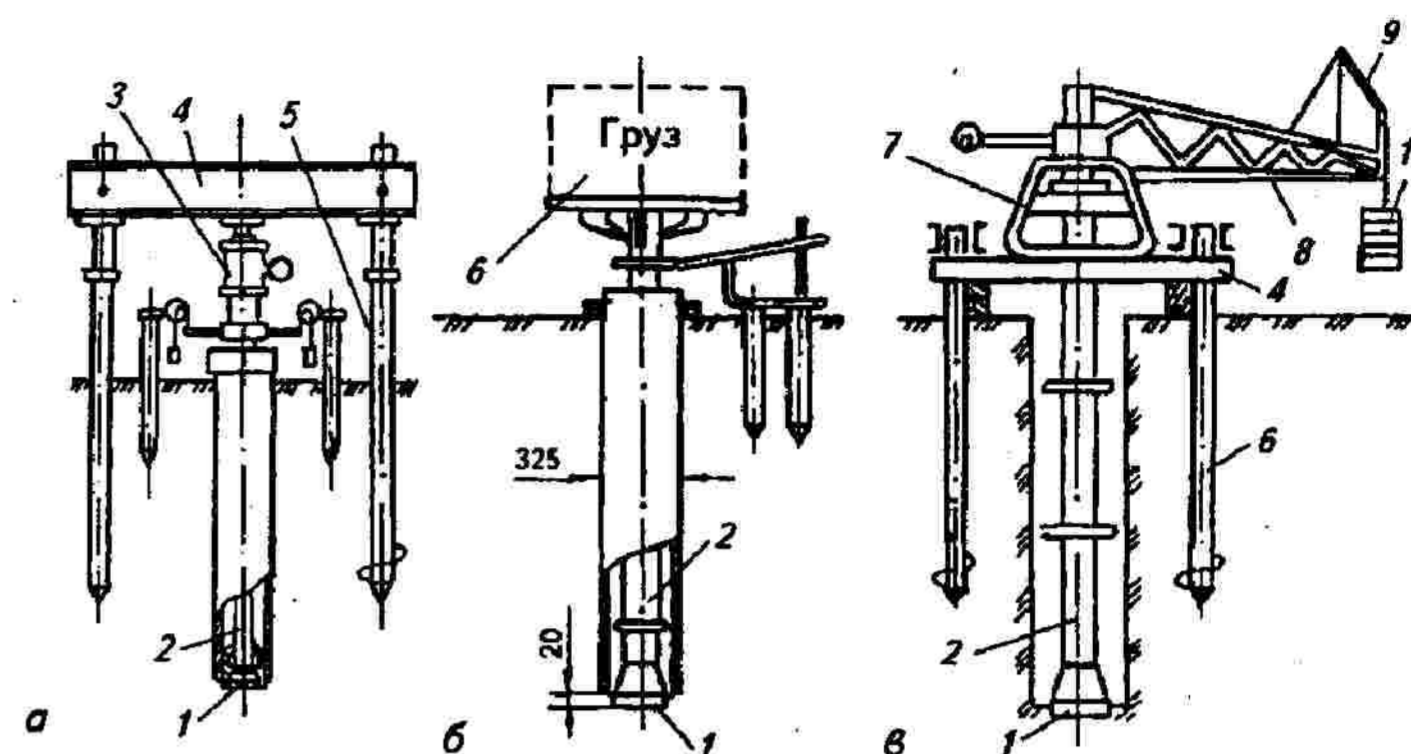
Конструкции установок для испытания грунтов в скважинах: а — штамп с анкерными сваями; б — штамп с грузовой платформой; в — канатно-рычажная установка КРУ-600; 1 — штамп; 2 — стойка; 3 — домкрат; 4 — балка; 5 — свая; 6 — платформа; 7 — рама; 8 — рычаг; 9 — сегмент для груза; 10 — груз
